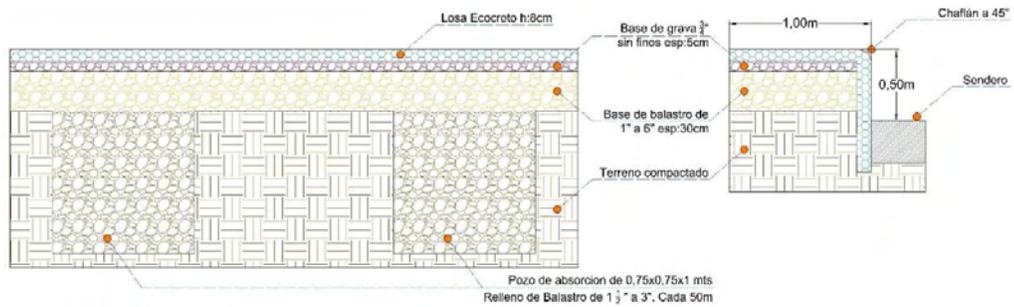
Detalle Ecocreto para senderos. Fuente: Elaboración Propia
